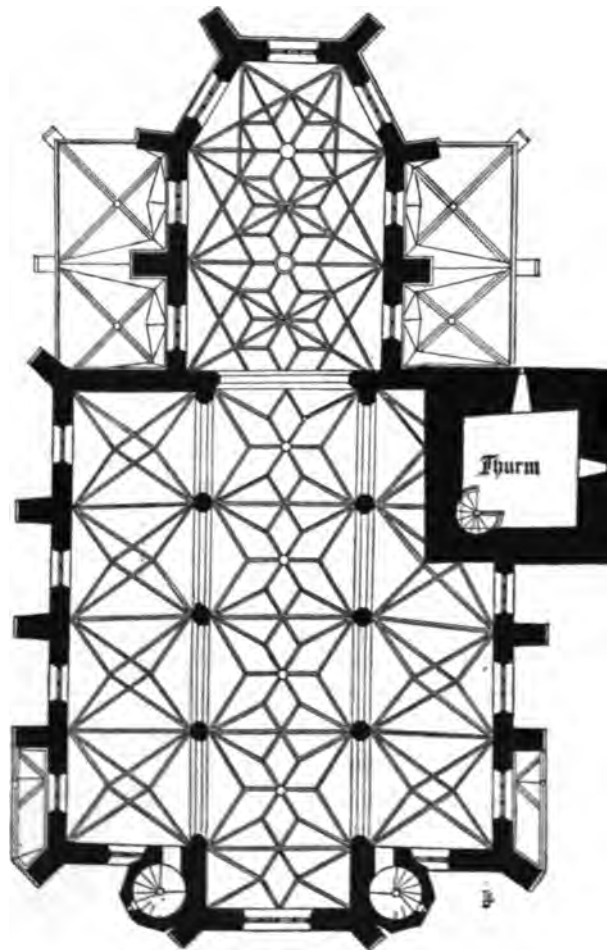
Oestrich. Pfarrkirche. Grundriss.
